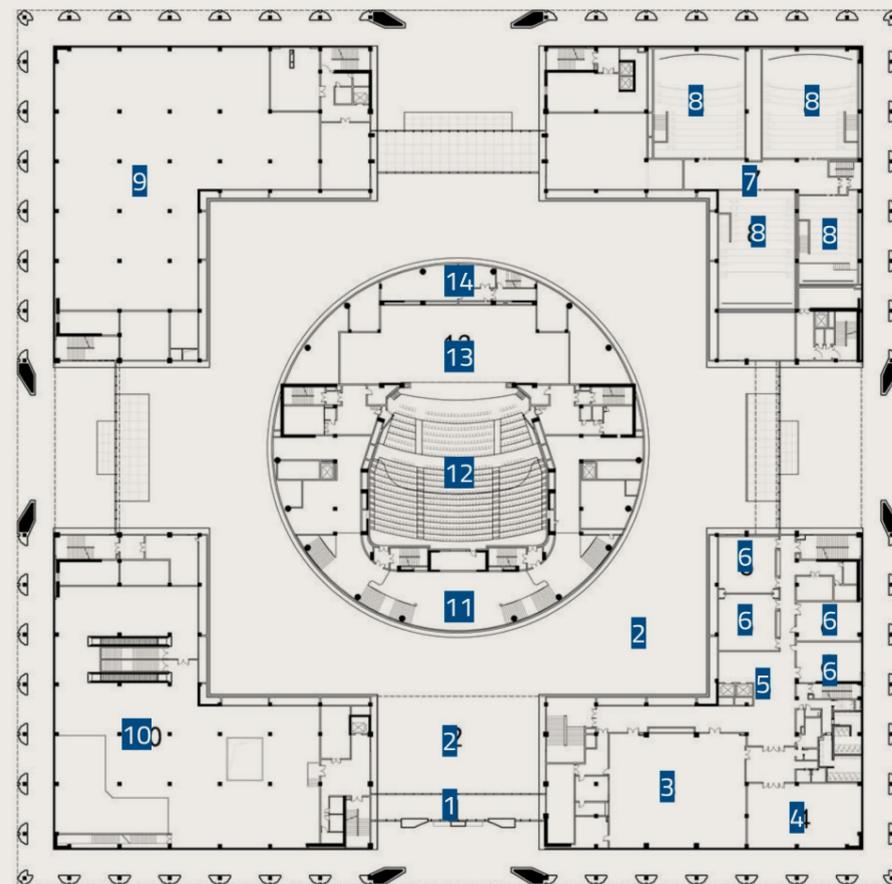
Planta do Primeiro Pavimento. 0 5 10 20m
